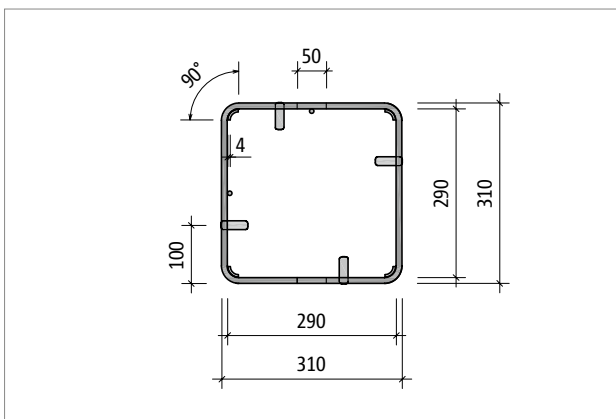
Schöck Scconnex® Typ P-B350: Part T; geschweisste Bügel und Biegeformsegmente aus Edelstahl
